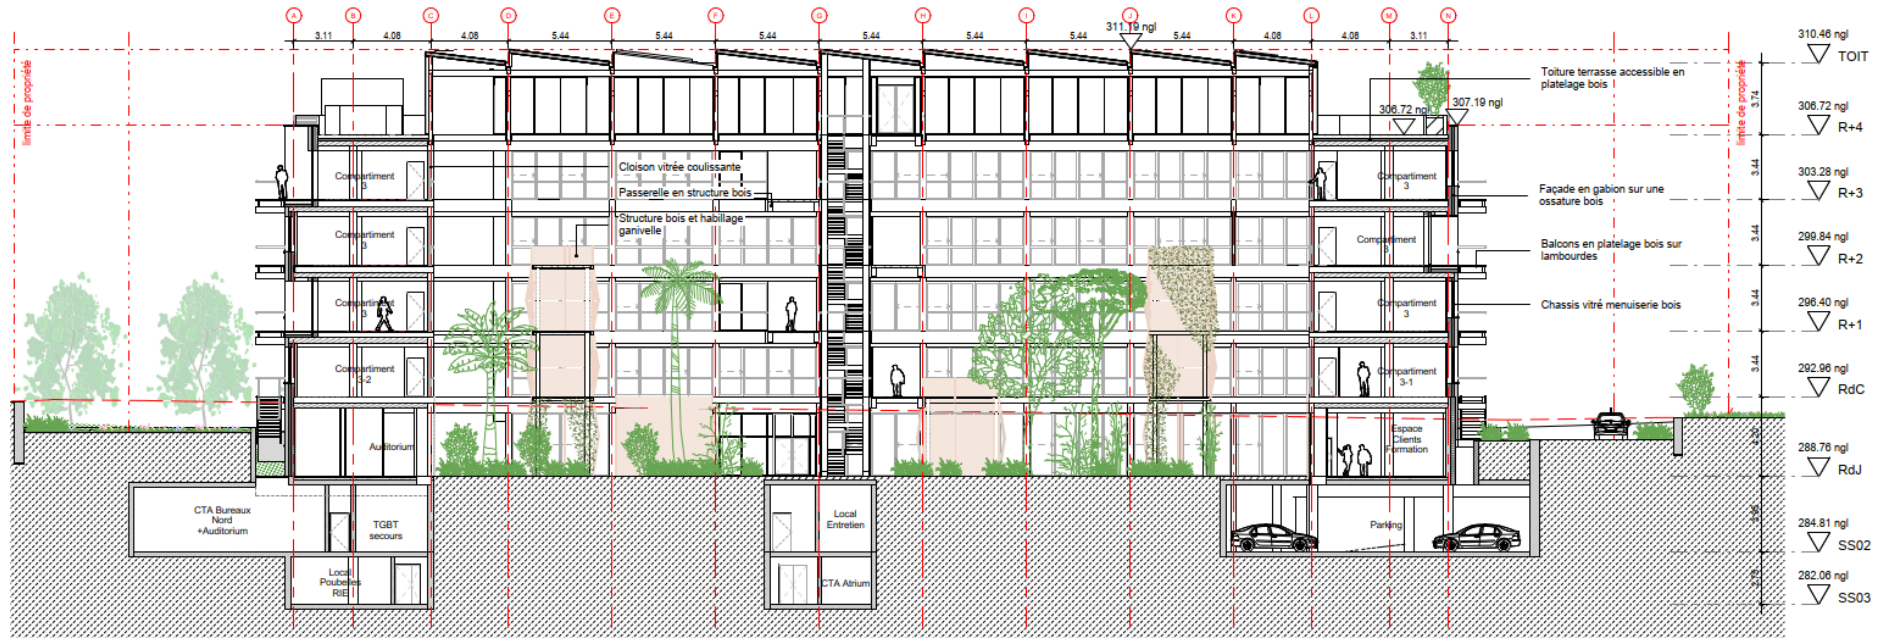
Querschnitt des Gebäudes mit Blickrichtung aus Westen (Maison Edouard François 01/2023). Größere Darstellung in Anhang 04 Seite 14.
